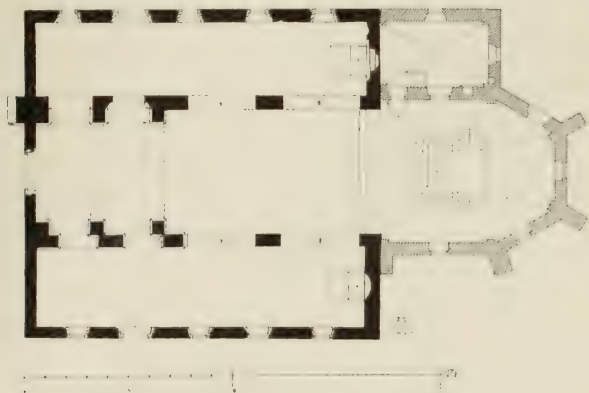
Gleuel Grundriss der abgebrochenen Pfarrkirche
